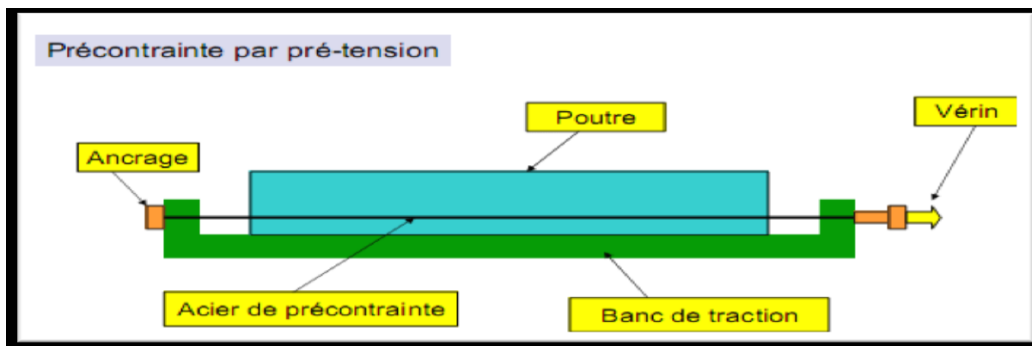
Coupe longitudinale d'une poutre en béton précontraint par pré-tension.
